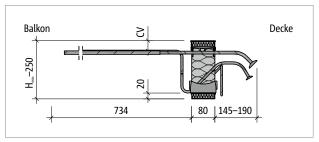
Schöck Isokorb® T Typ K-O-M4: Produktschnitt
